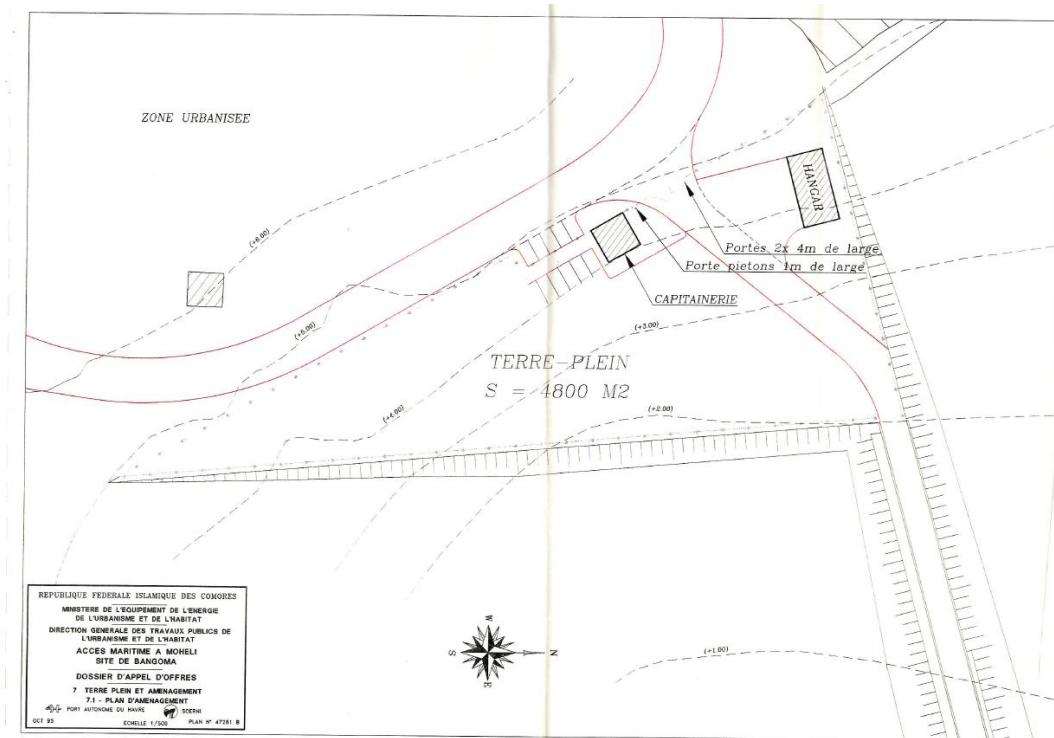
Plans issus du dossier d'appel d'offres [R30]
